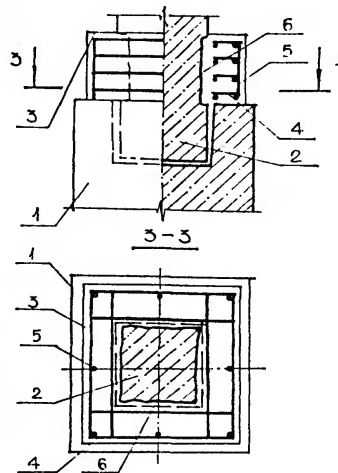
Устройство железобетонной обоймы вокруг колонны
